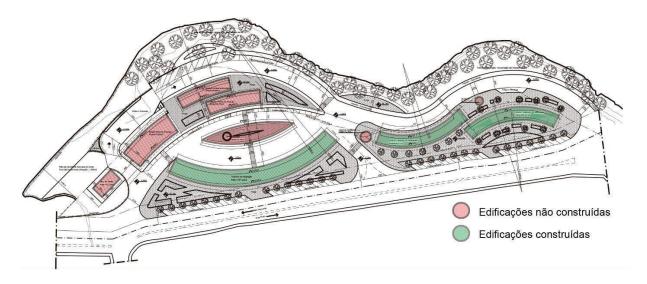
Projeto original de implantação do Terminal Rodoviário e Praça do Artesão de Cachoeira do Campo. Edificações construídas x não construídas.
